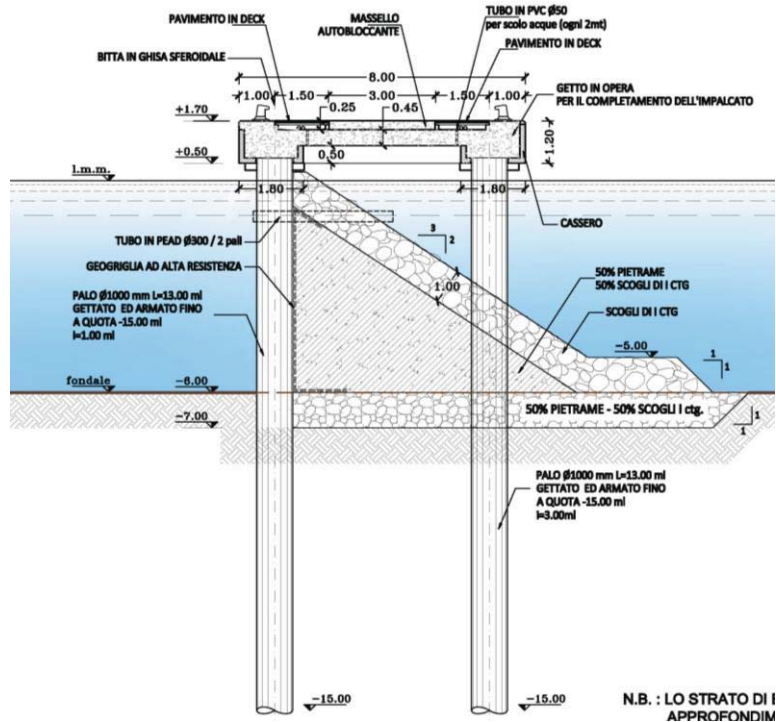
Sezione tipo di intervento sul pontile di attracco dei megayachts
